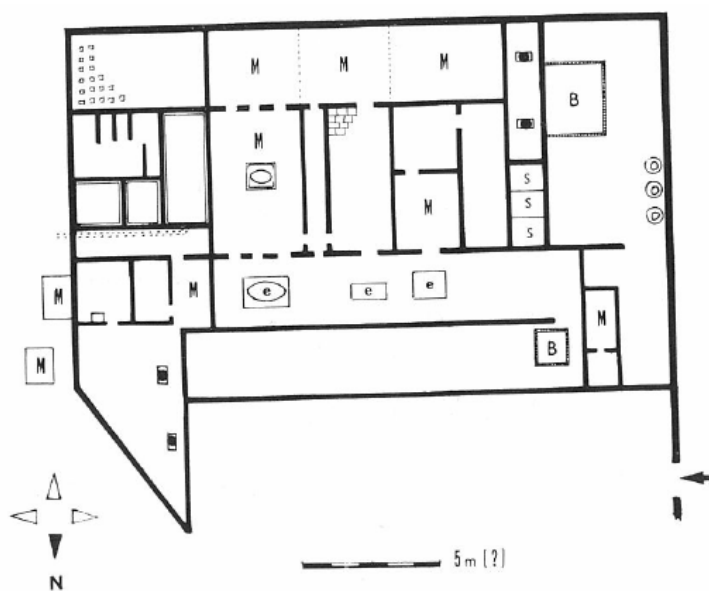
Planimetría de la *villa* de Puig de Cebolla.
